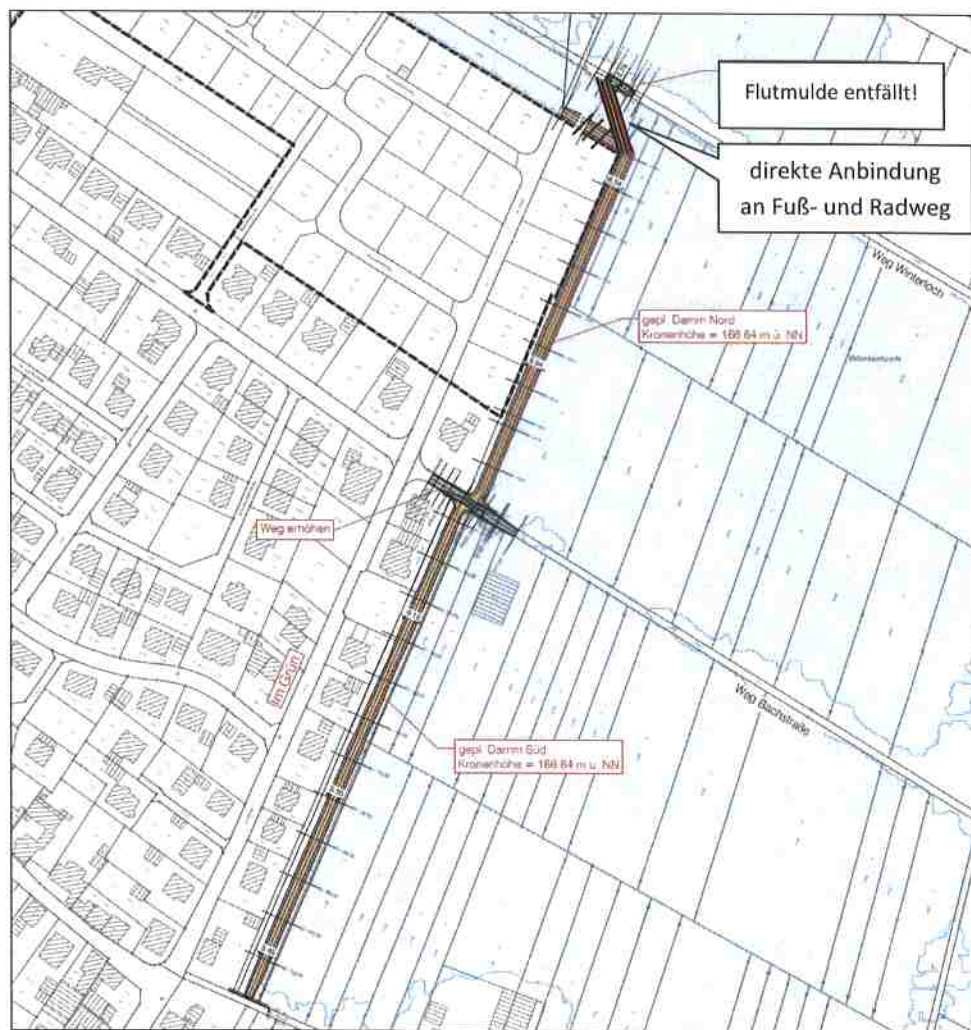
Lageplan Planung Hochwasserschutz „Im Grün“
